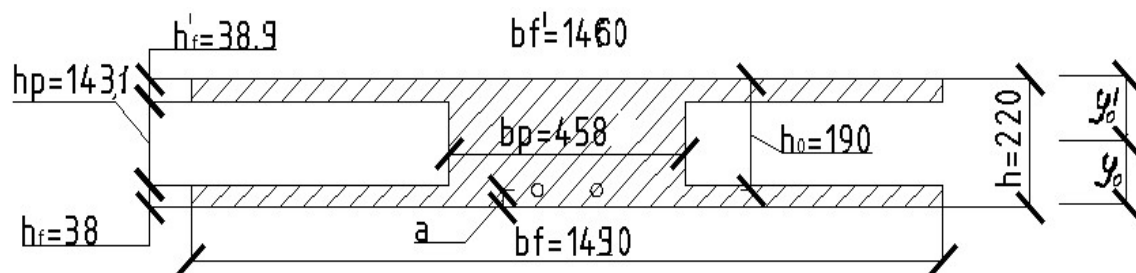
Розрахунковий перетин плити для розрахунків по другій групі граничних станів.
